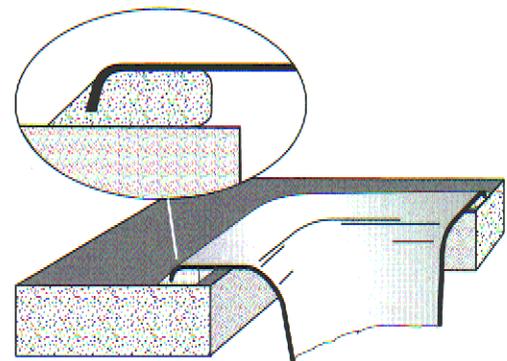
Abdichtung mit untergelegtem Dichtungsprofil
